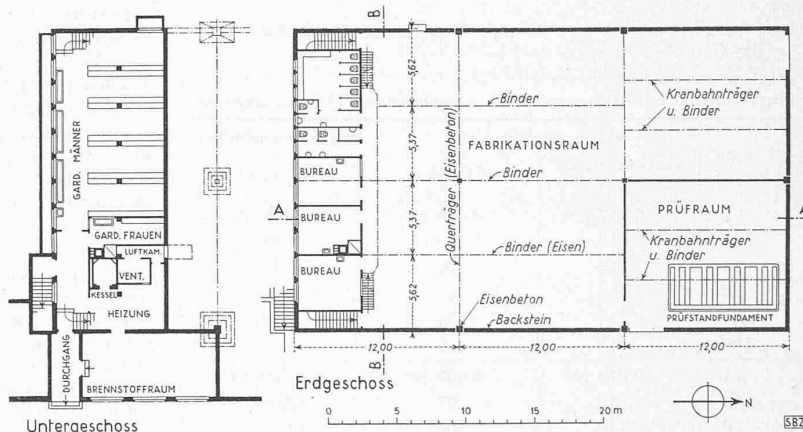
Bau von 1942. Grundrisse 1:500
